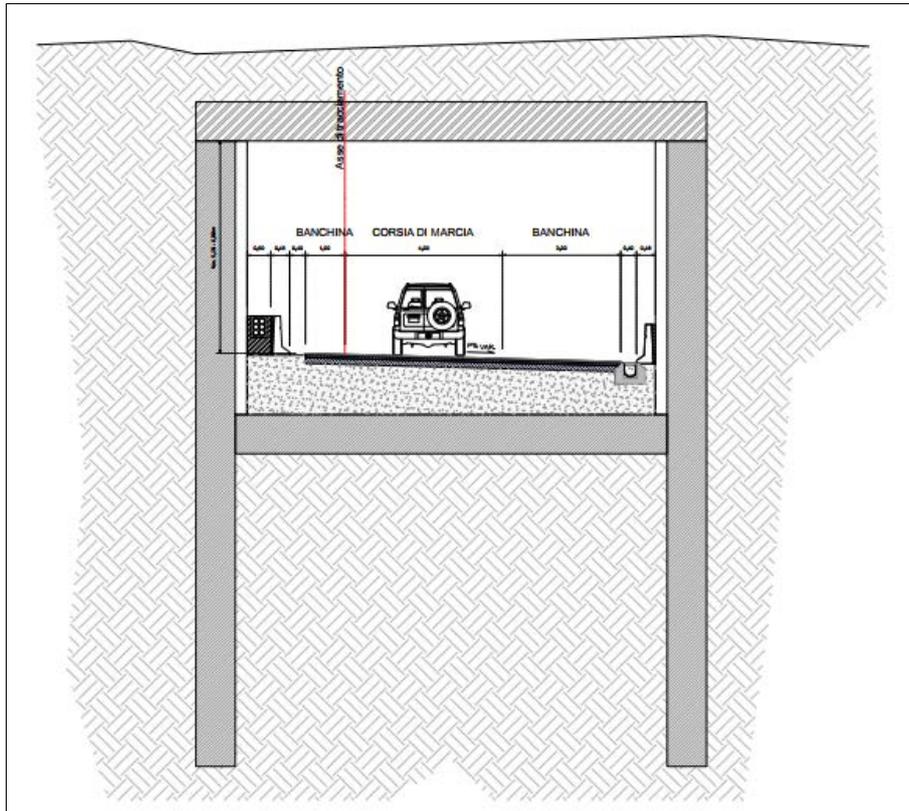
Sezione Tipo del tratto in trincea con diaframmi lungo il Ramo 1
